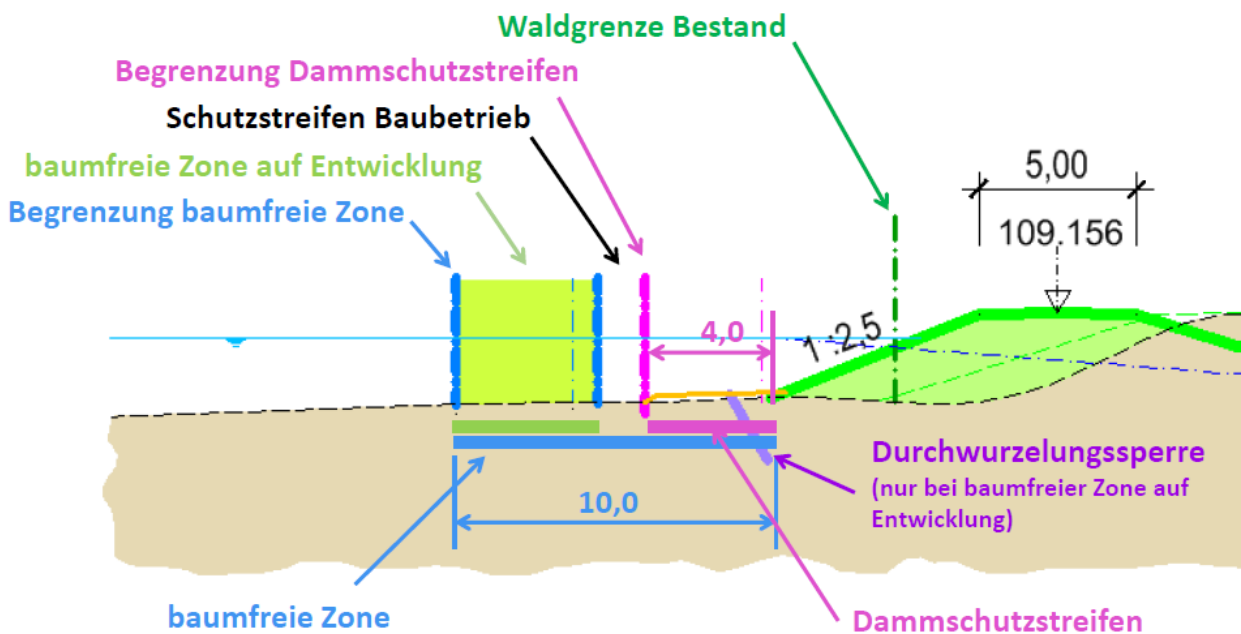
Variante D, Detaildarstellung Rheinseite mit Elementen
